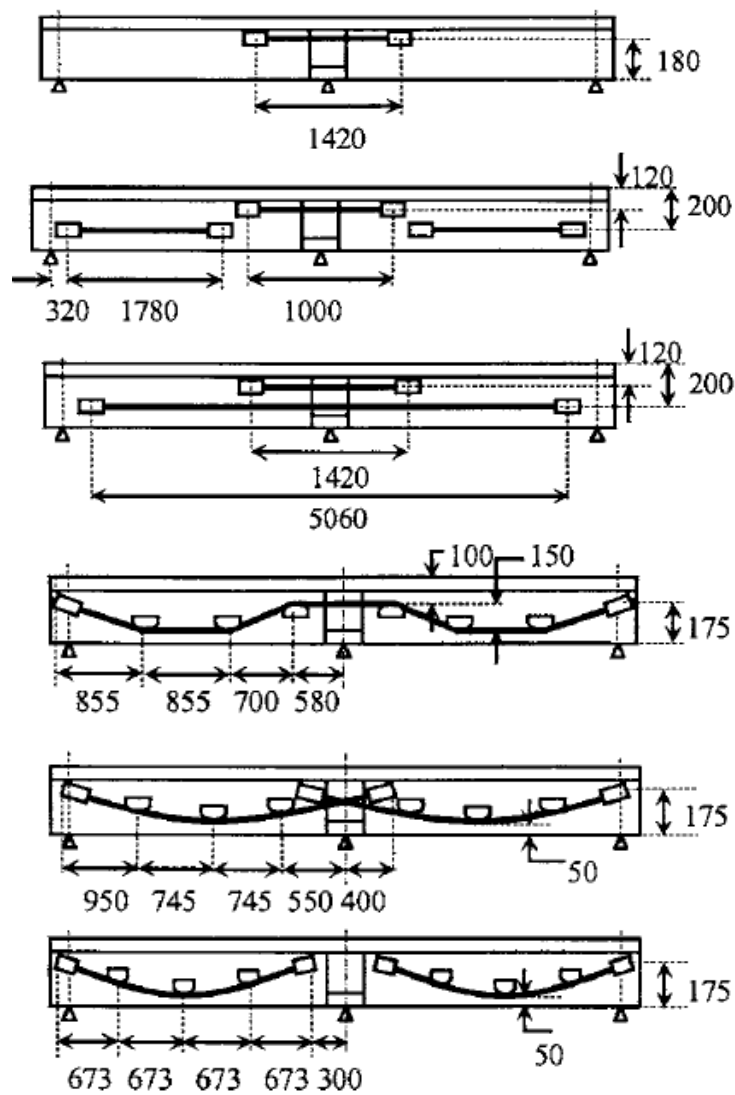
Tipos de configuração do reforço por protensão externa (medidas em mm) (TAN e TJANDRA, 2007)
